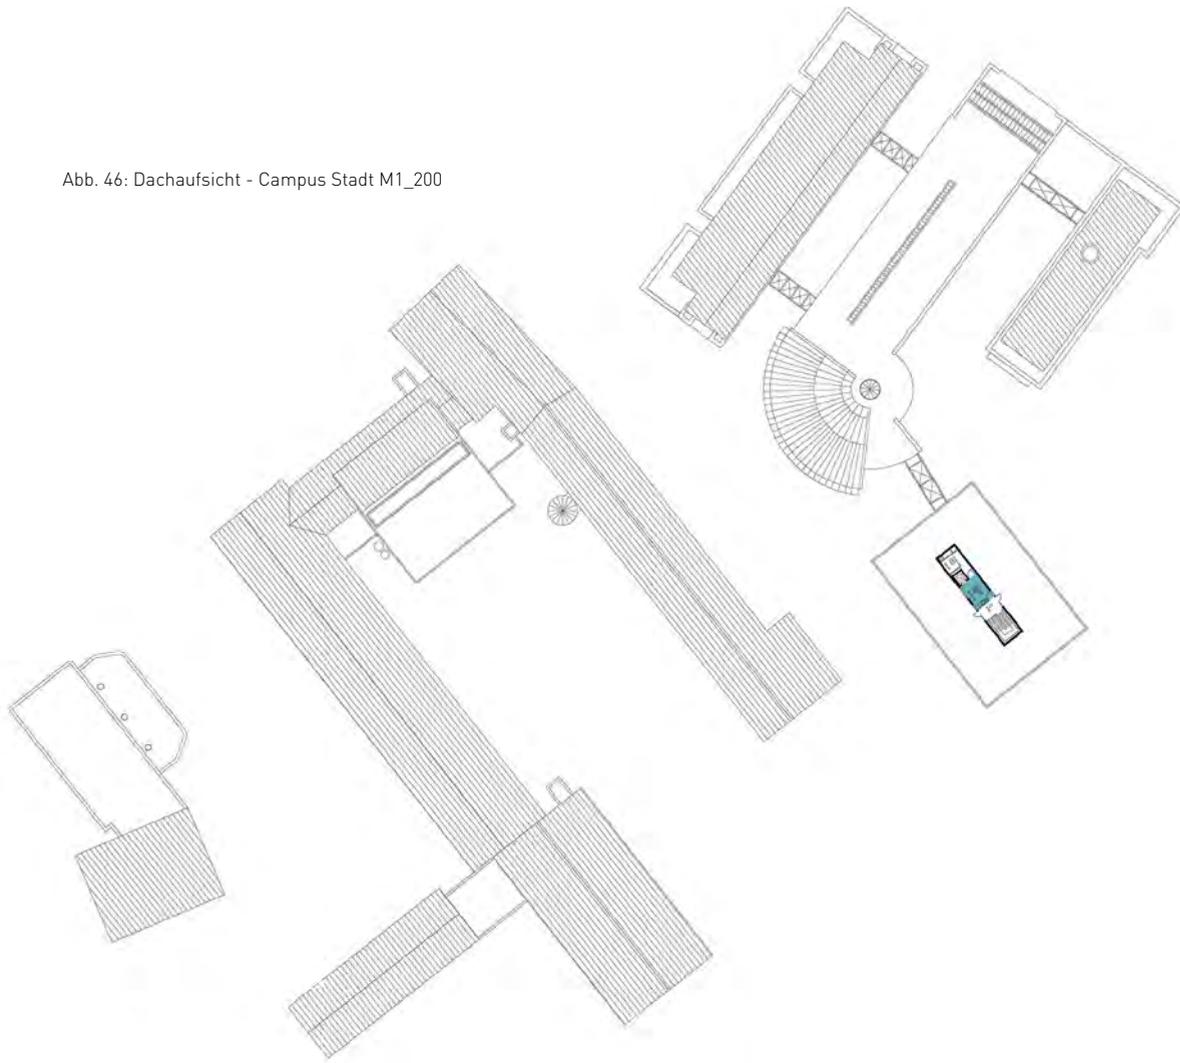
Dachaufsicht - Campus Stadt M1_200
